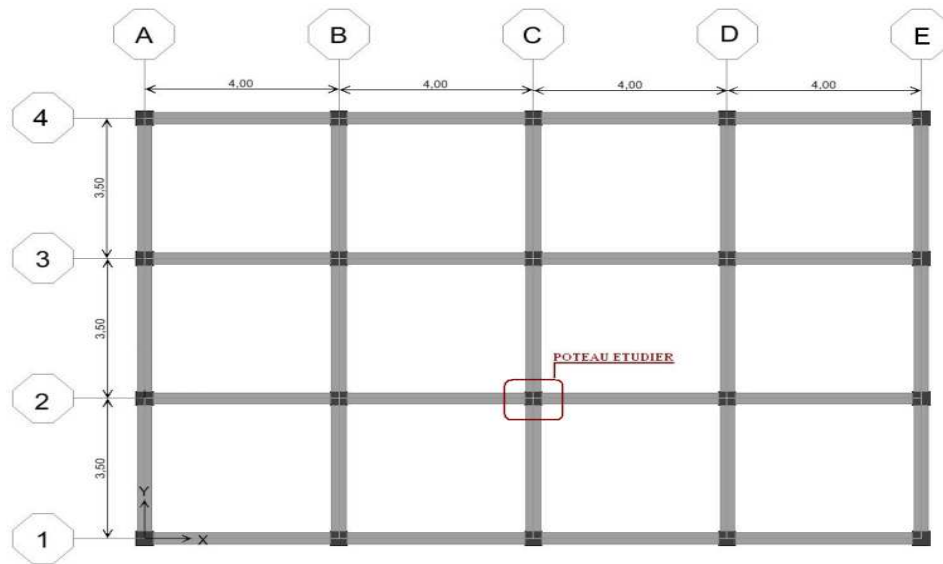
Les plans et les coupes nécessaires du bâtiment (N=1) (BN1)
